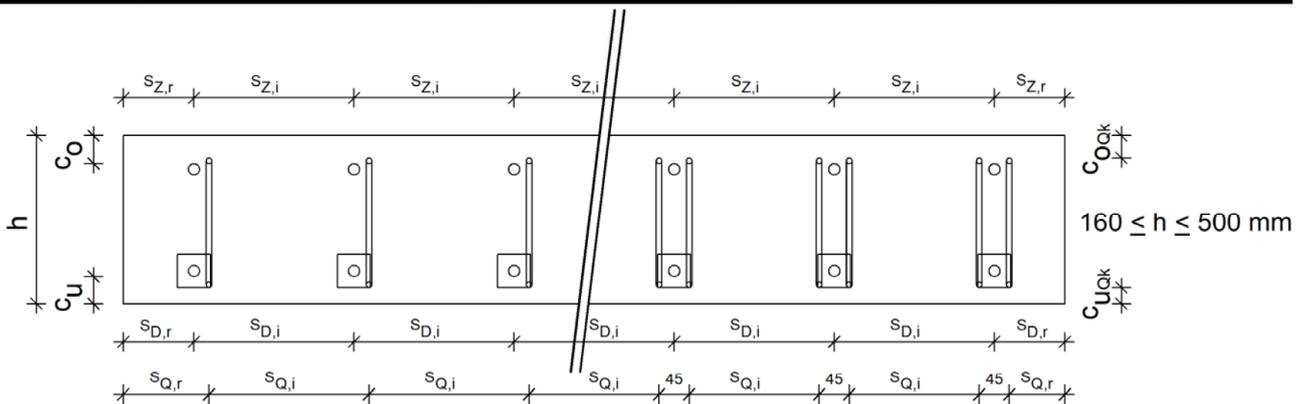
Geometrische Randbedingungen Darstellung mit einer und zwei Querkraftstabschlaufen je Drucklager
